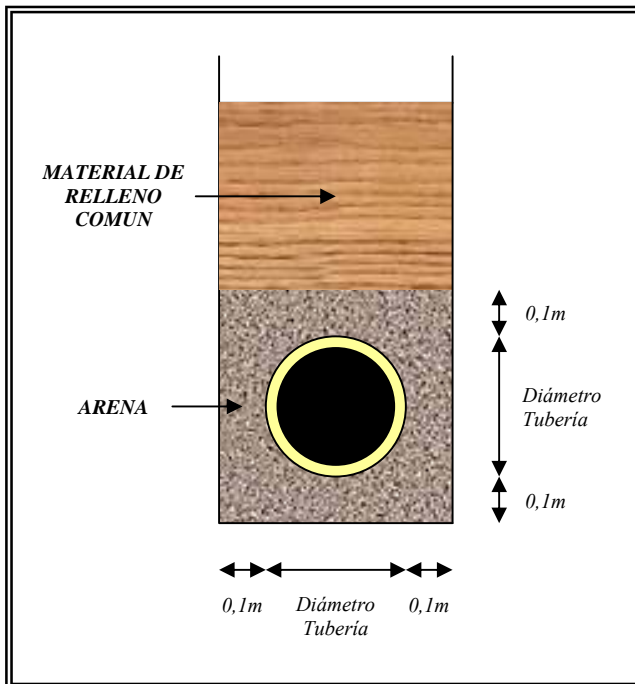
Cimentación En Arena Para Tubería De P.V.C. Estructural.
